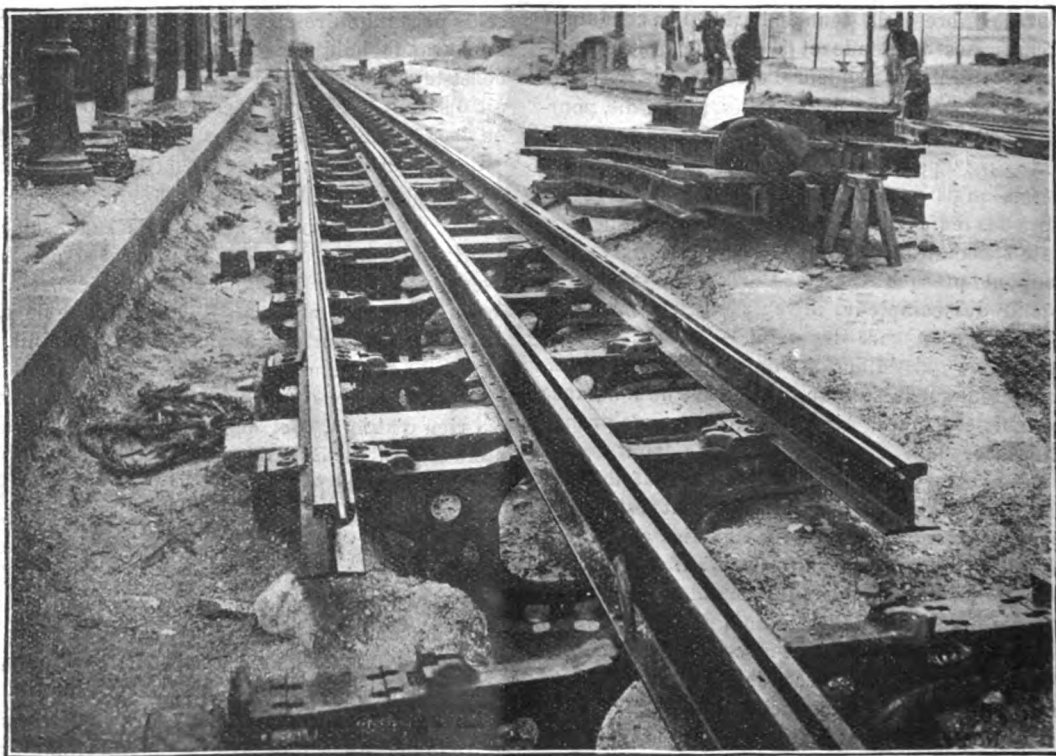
CANIVEAU EN CONSTRUCTION.
